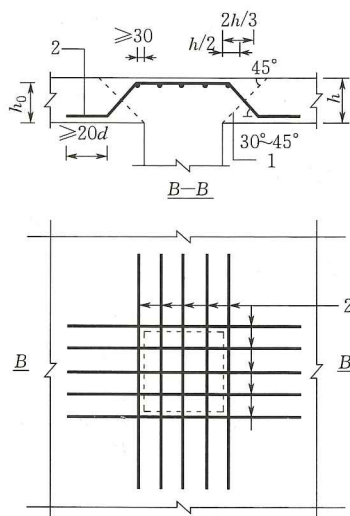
用弯起钢筋作抗冲切钢筋布置图(单位:mm)
